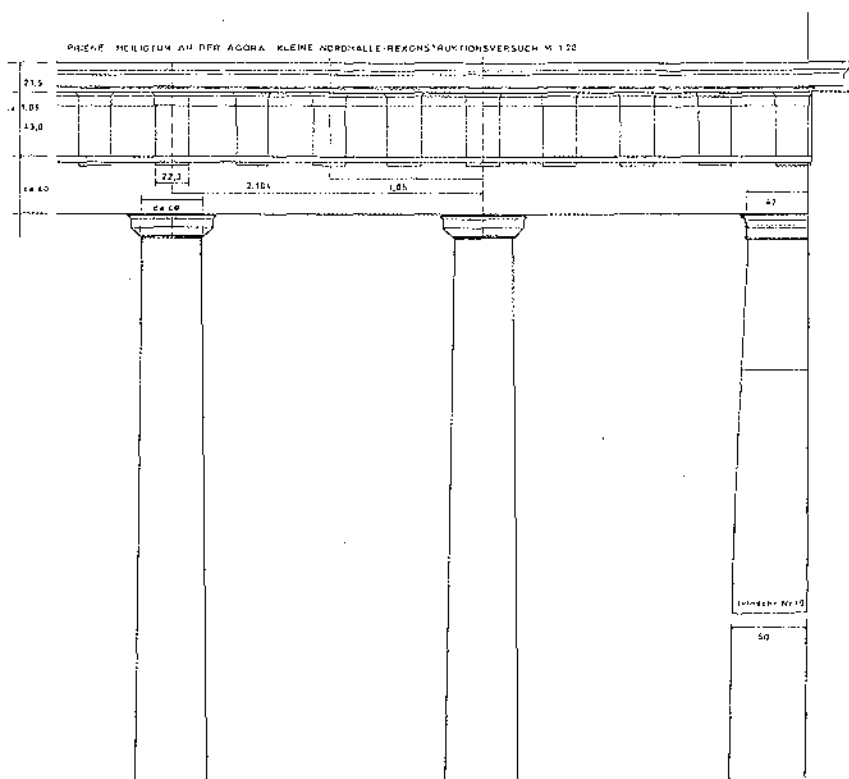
Priene, Asklepieion. Rekonstruierte Halle
